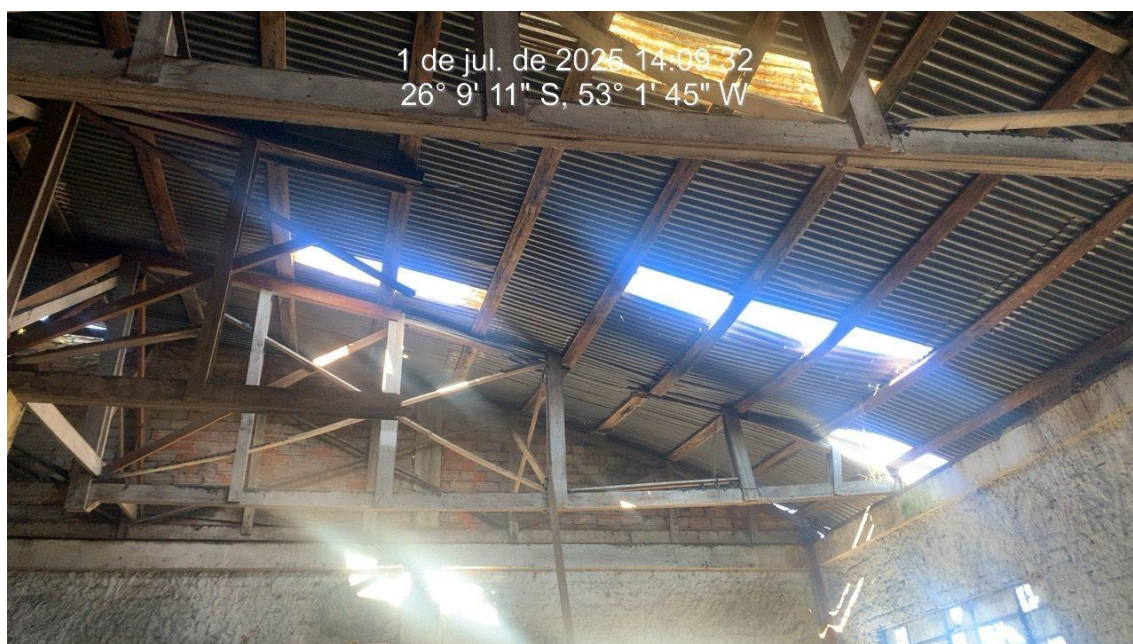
Estruturas de tesouras em madeira com rachaduras e risco iminente de colapso.
